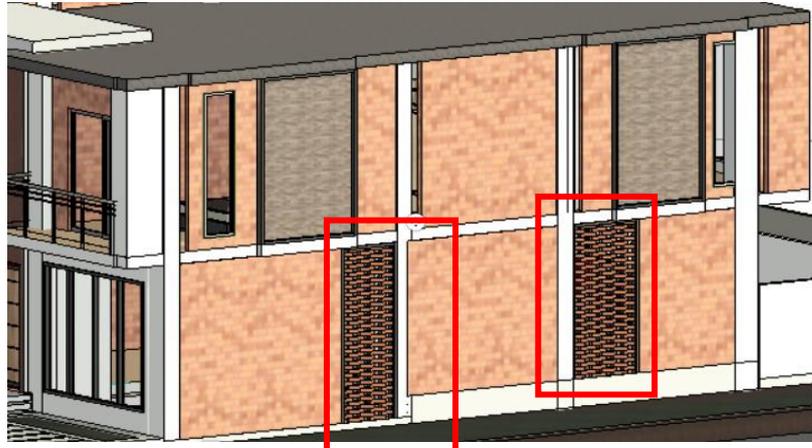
Modelo BIM 02, aplicación de muro aparejo en planta baja.
